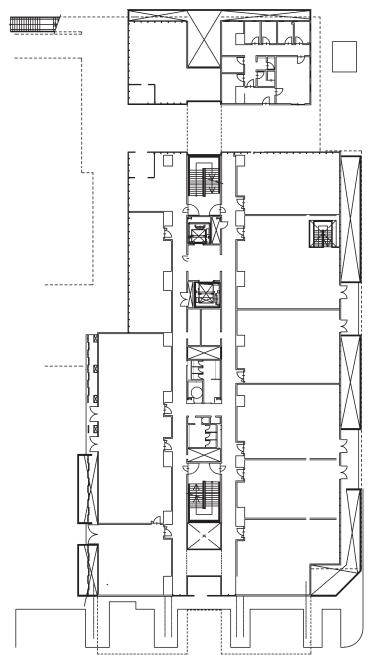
(3) 高層棟平面図（地上 12 階～地上 16 階）(3/3)
